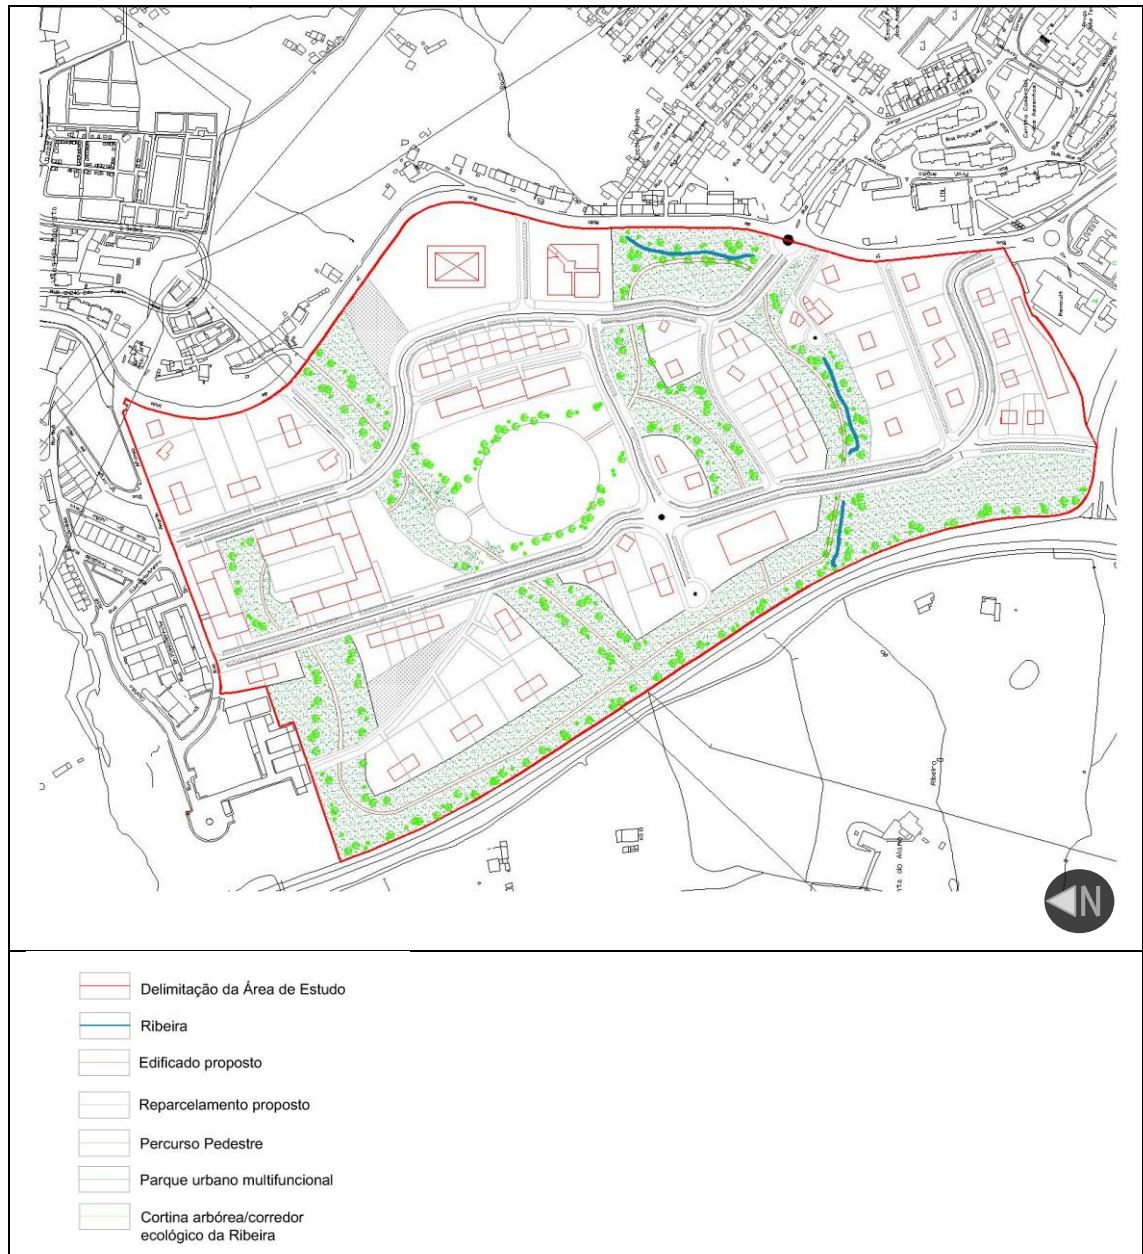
Elementos naturais da proposta (FONTE: *autor*), [PLANTA B/30]; (Escala: gráfica)
